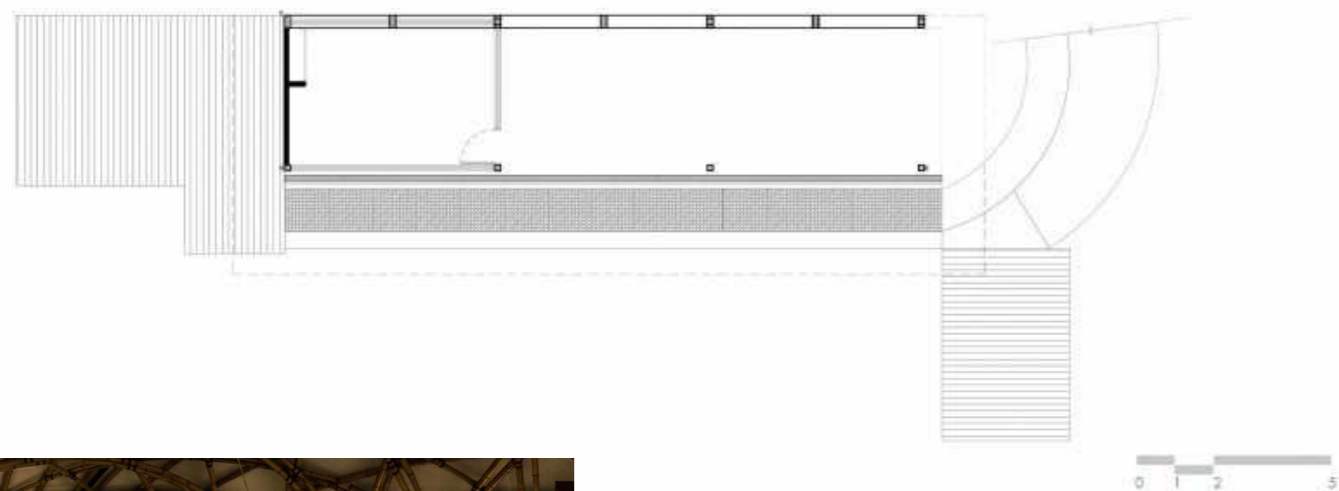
Planta pavimento inferior. Fonte: SustentArqui.
